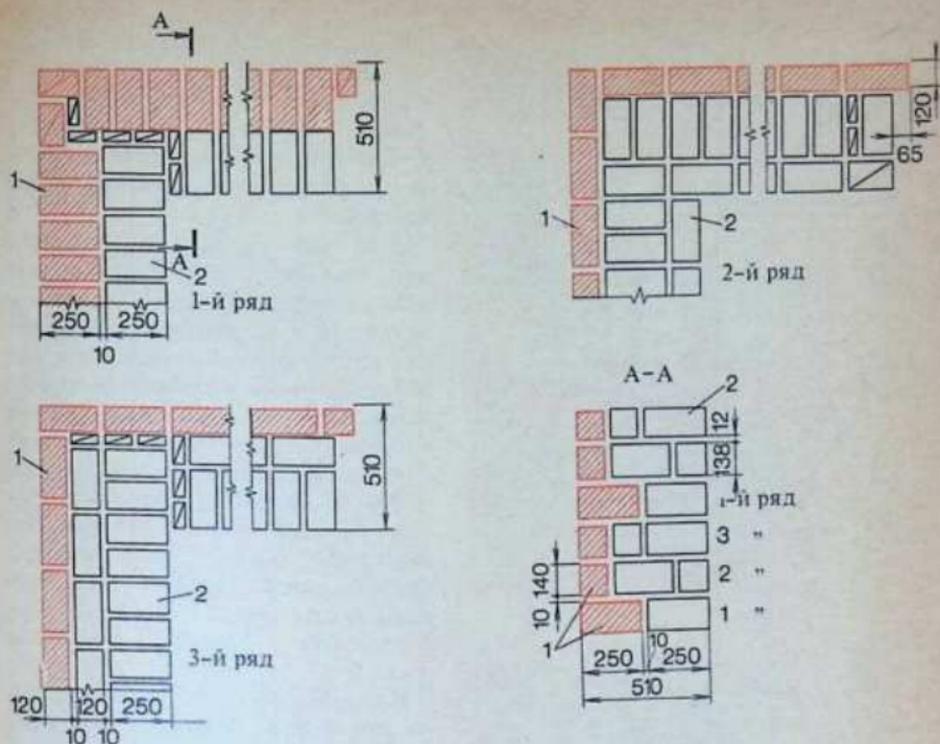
Перевязка кладки из керамических камней с облицовкой керамическими камнями из светложгущихся глин:
